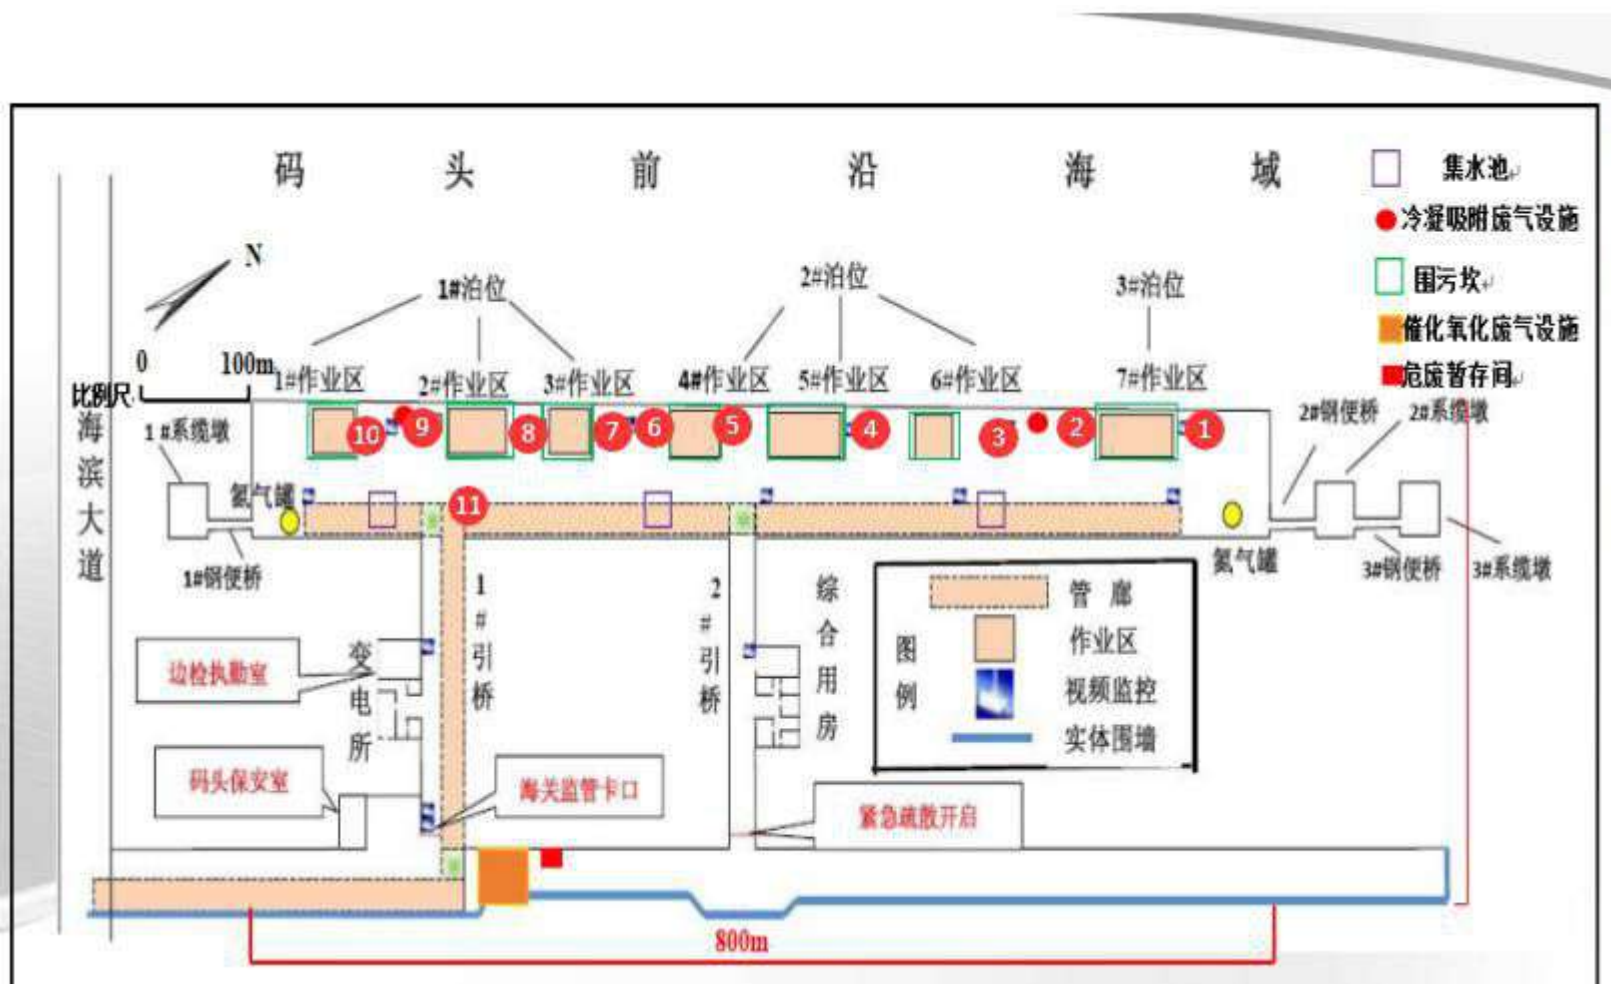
液体化工码头平面布置图（事故水池及固废贮存场均位于后方库区内）
